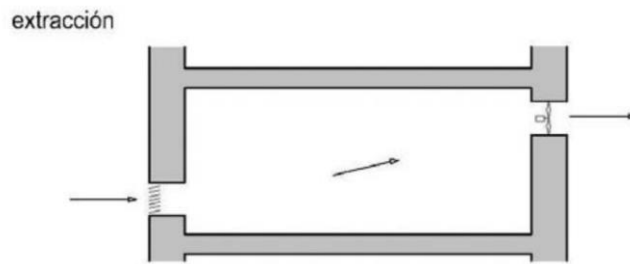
extracción de aire en edificio prefabricado. Fuente: UPM.
